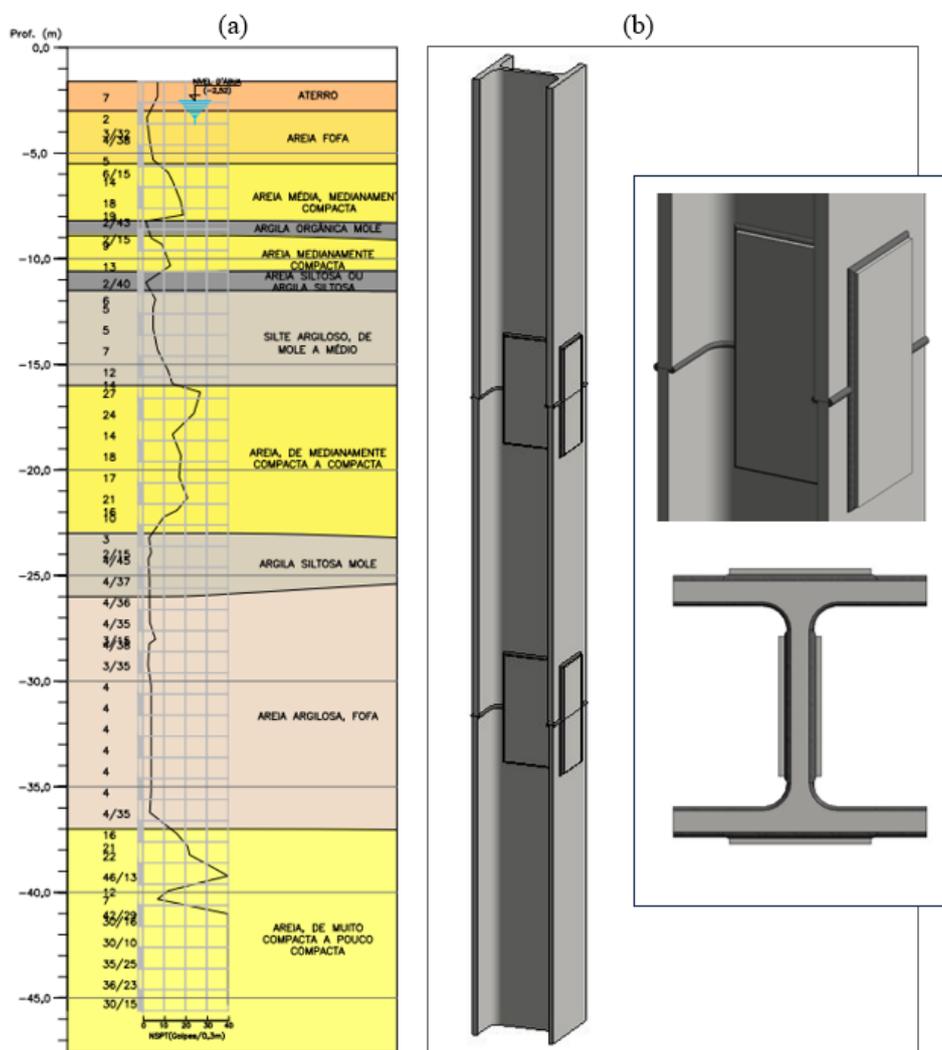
(a) Perfil simplificado. (b) Seção transversal, vista 3D e detalhe das emendas das metálicas compostas por perfis laminados (sem escala).
